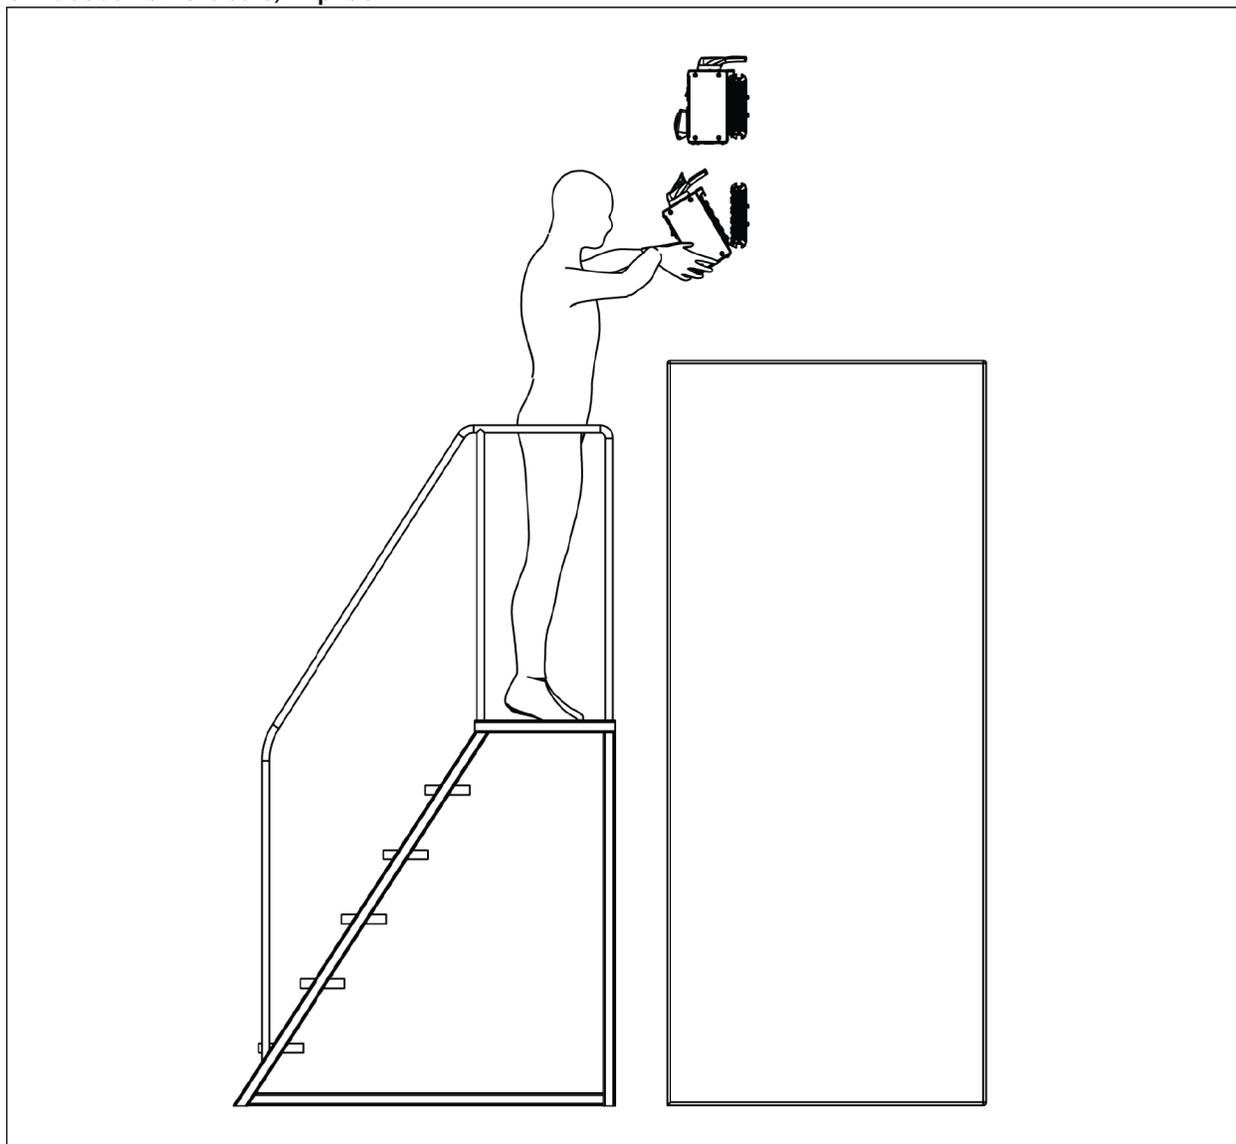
Esempio di installazione della cassetta di derivazione: sopra il rack con impianto singolo di blindosbarra orizzontale
